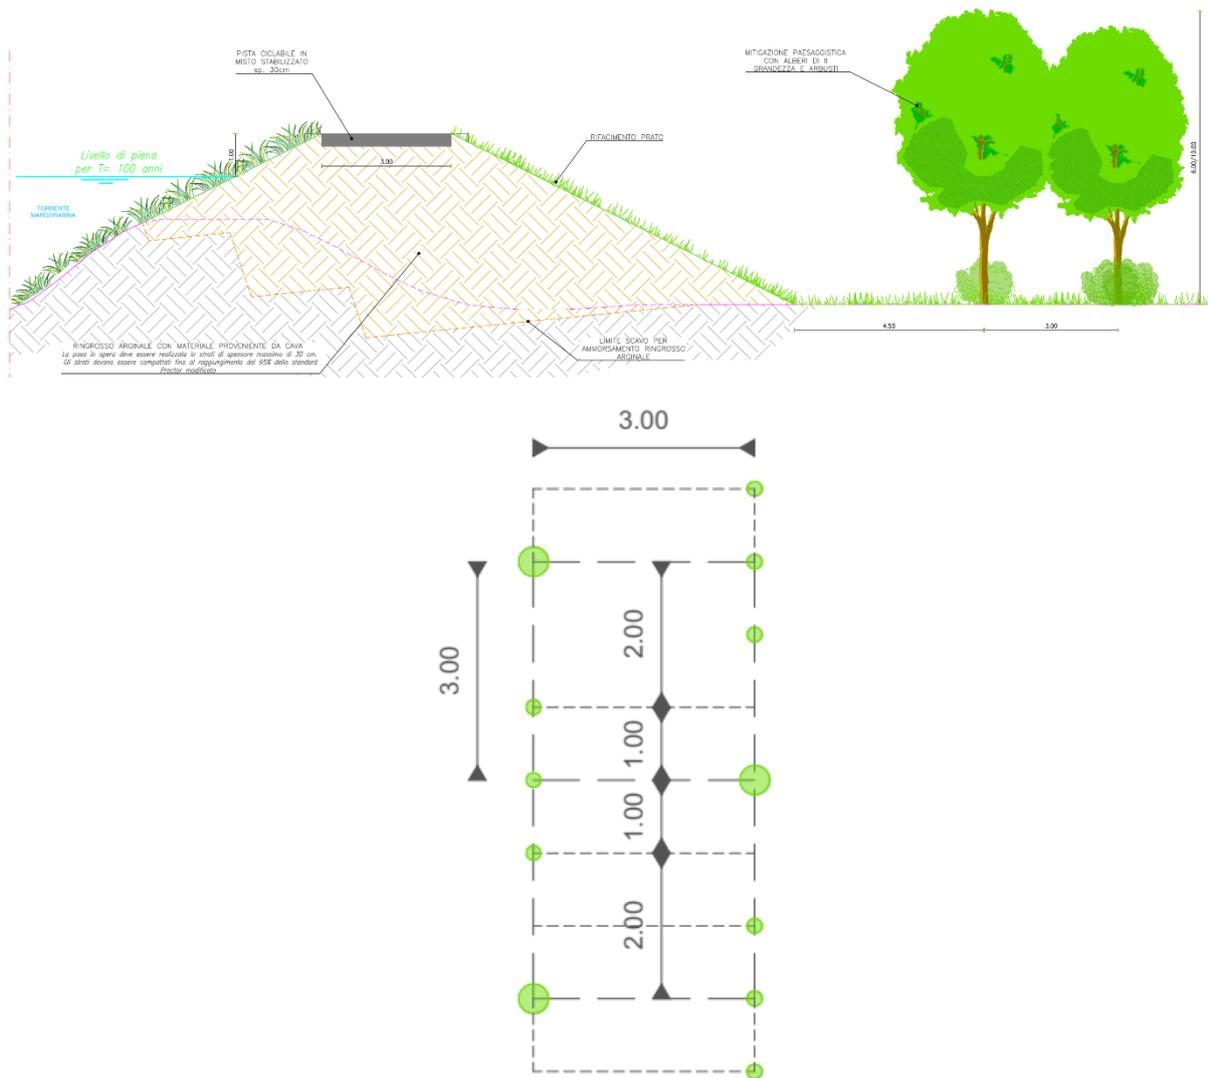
Planimetria, sezione tipologica e sesto d’impianto mitigazione tipo A
